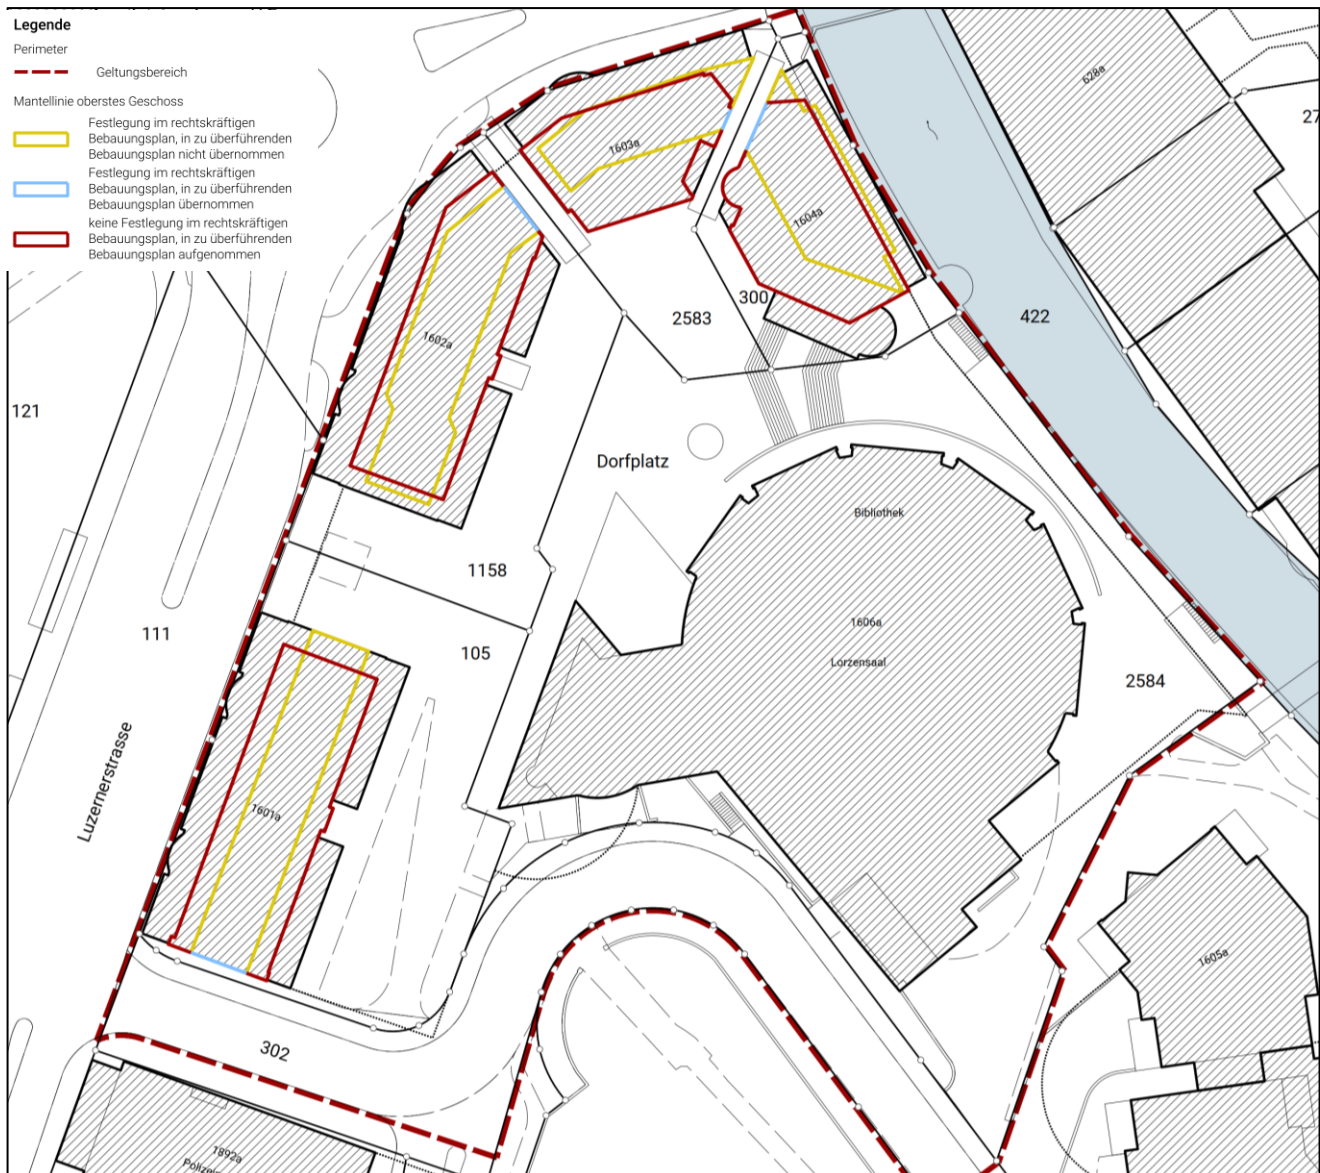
Differenzplan Dimensionierung der Mantellinie für das oberste Geschoss. Vergleich rechtskräftiger und überführter Bebauungsplan
